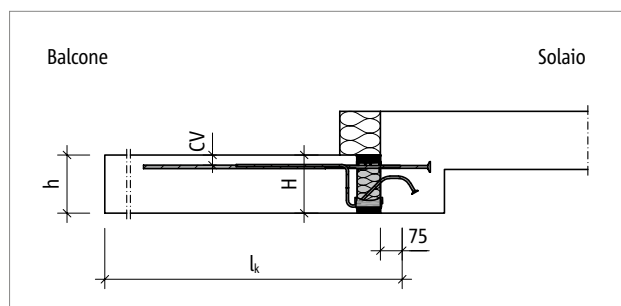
Schöck Isokorb® T tipo KL-U: sistema statico
